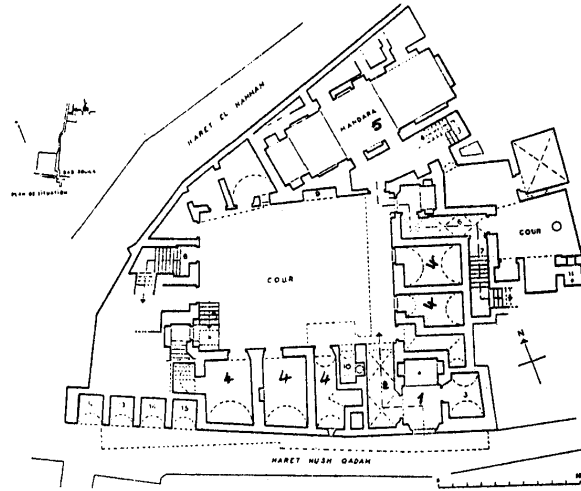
مسقط أفقي لمقعد منزل الكريدلية .
